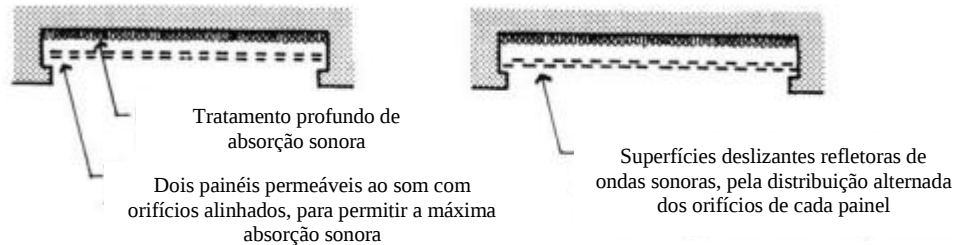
Superfícies deslizantes (adaptado de [4])
